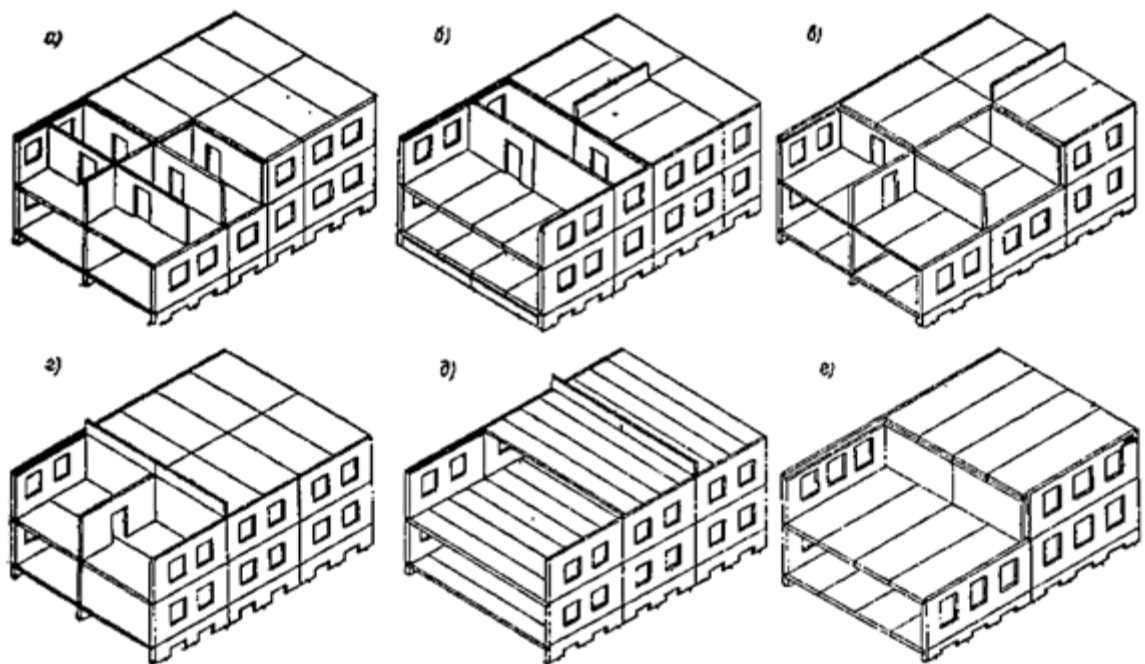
Конструктивні схеми бескаркасных будівель
